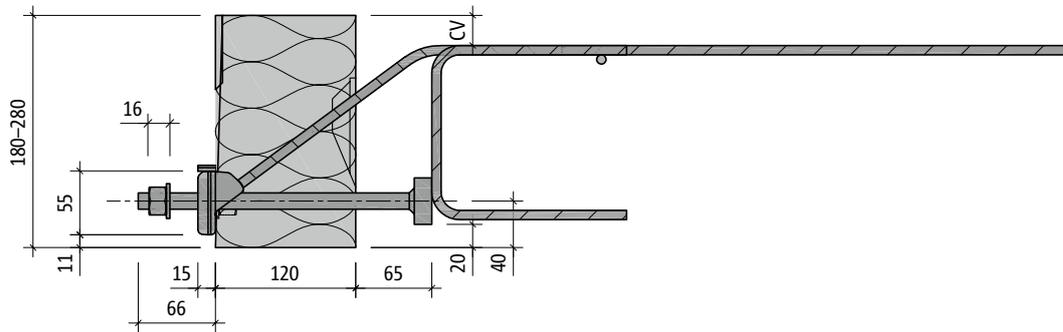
Schöck Isokorb® XT tipo SQ-V1: Sección del producto
